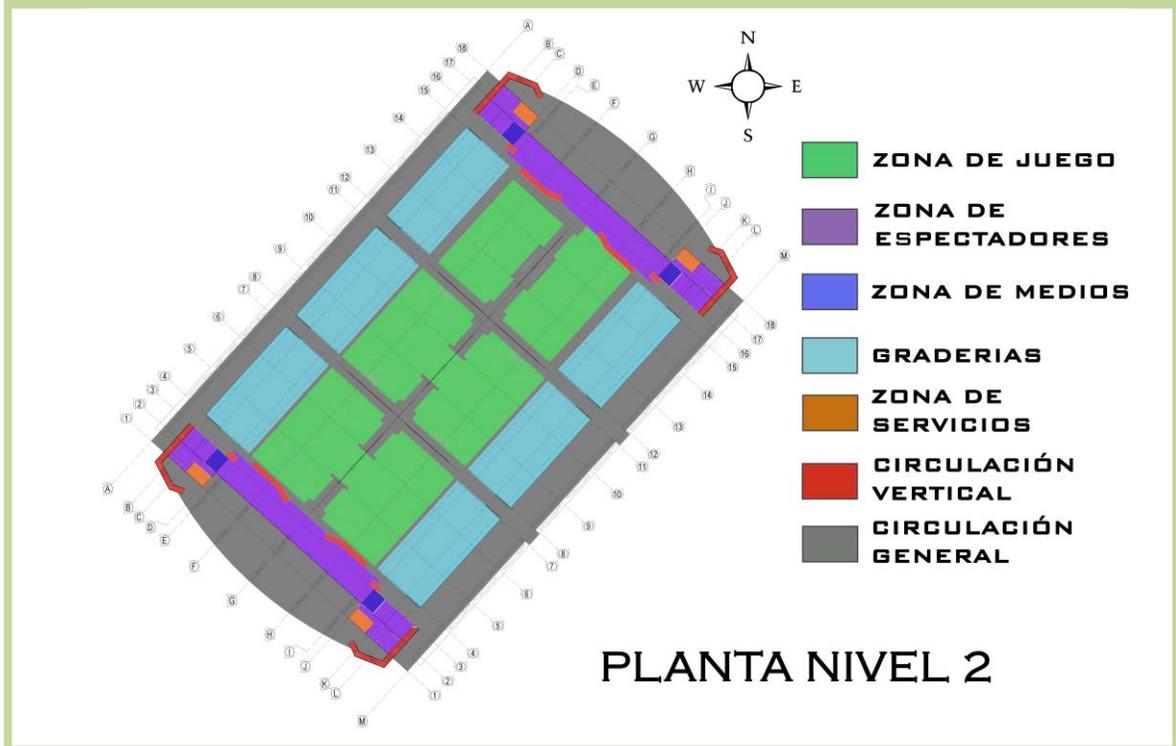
Zonificación coliseo - planta nivel 2 - Fuente: Elaboración propia
